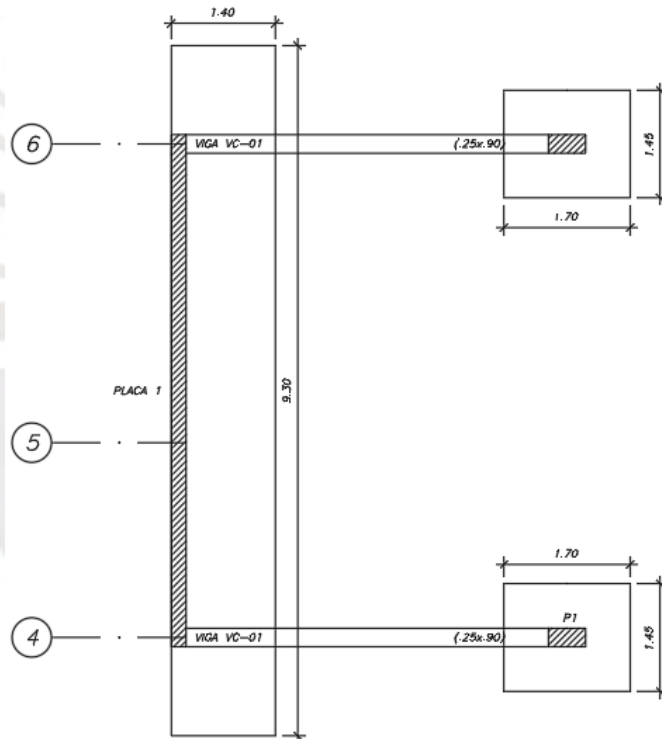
Zapata conectada por vigas de cimentación a columnas
